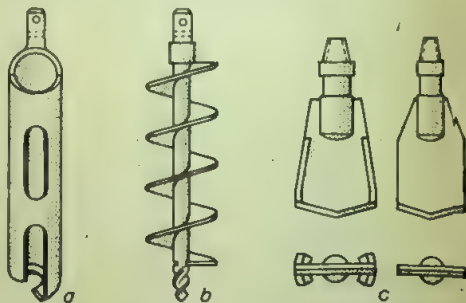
a Schappe und b Spiralbohrer für bindige Schichten, c Blattmeißel für feste Gesteinsbänke
